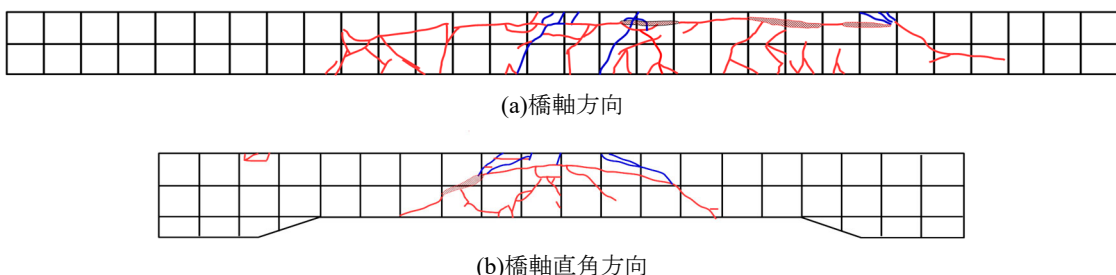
床版断面のひび割れ発生状況(上面塗布床版)
